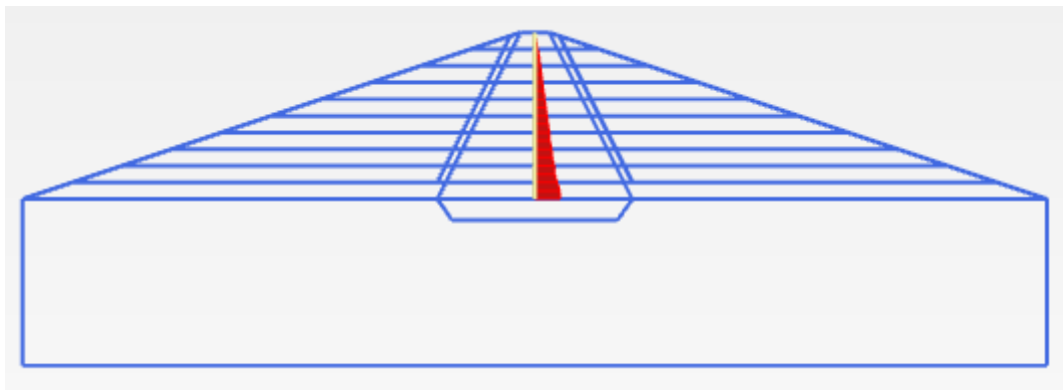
Secção definida para o estudo das tensões verticais do problema
